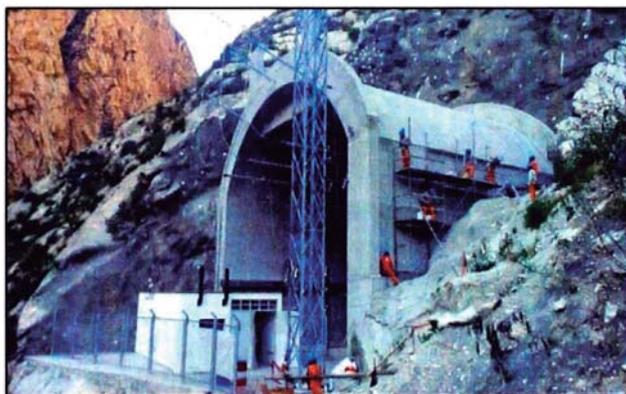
Vista Obra Civil en Portal Túnel Aire y Cables
